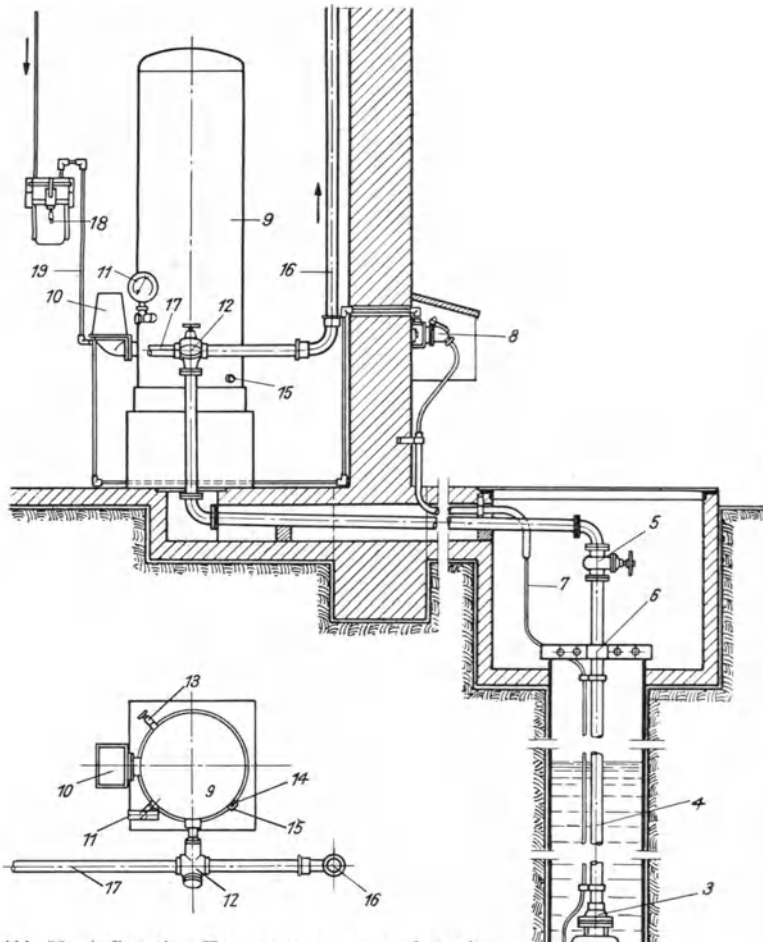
Aufbau einer Hauswasserversorgungsanlage mit Kleintauchpumpe und Druckkessel. (Garvenswerke.)
